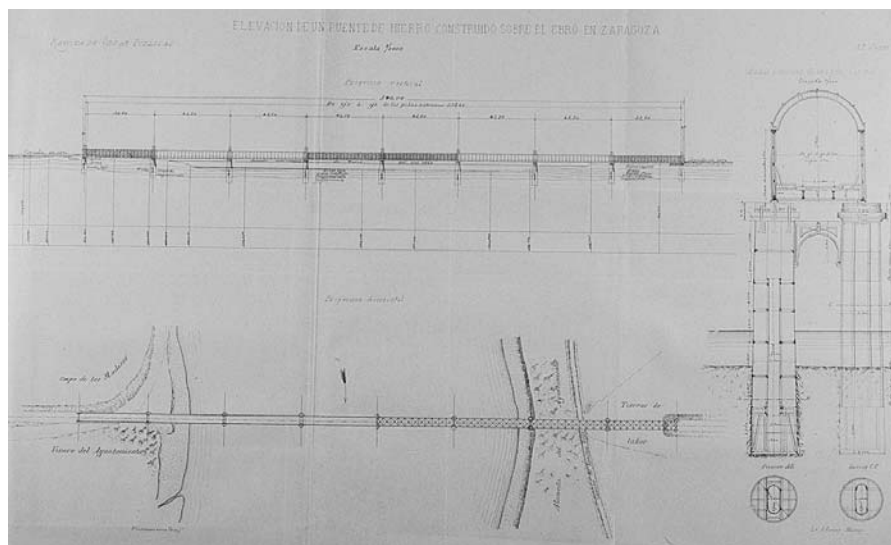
Proyecto de elevación de un puente de hierro construido sobre el río Ebro en Zaragoza, 1880.
